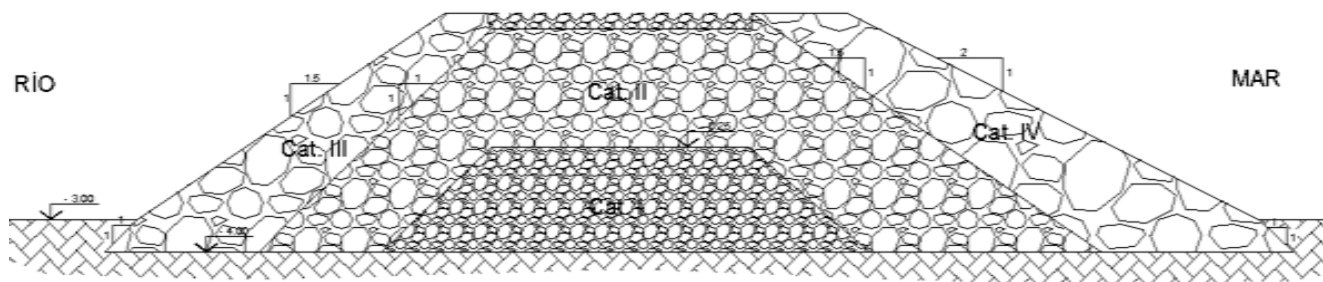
Perfil medio de la escollera luego de retirar los bloques de hormigón.
